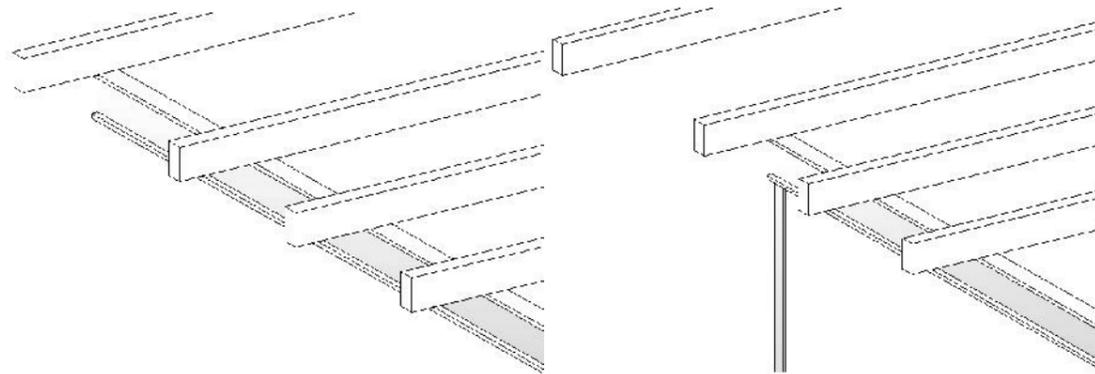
Modificación perfil IPE 200 y colocación de pilar metálico. Fuente: propia autora
